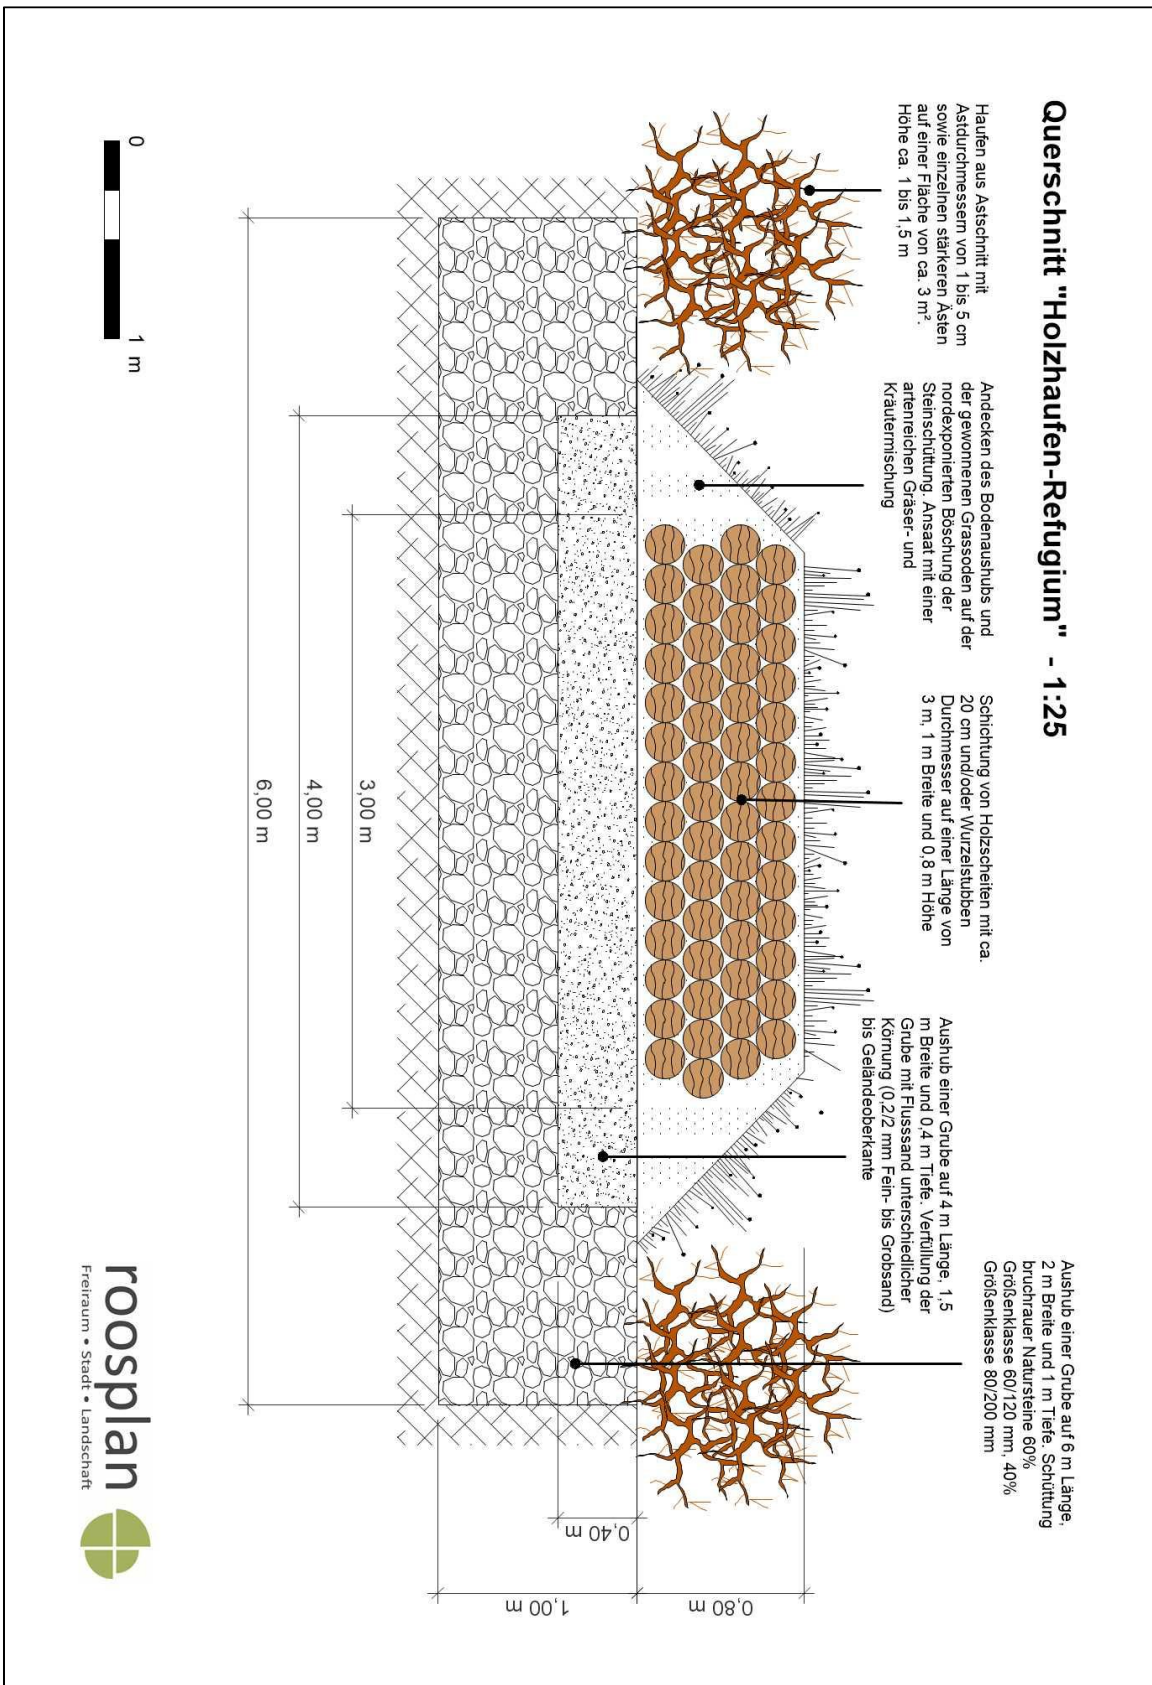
Detailskizze Holzhaufen-Refugium Querschnitt
